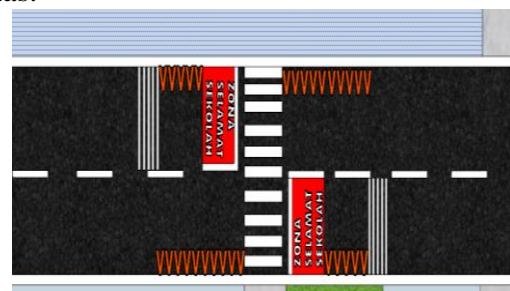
Gambar 3D upaya penyelesaian site plan kawasan
